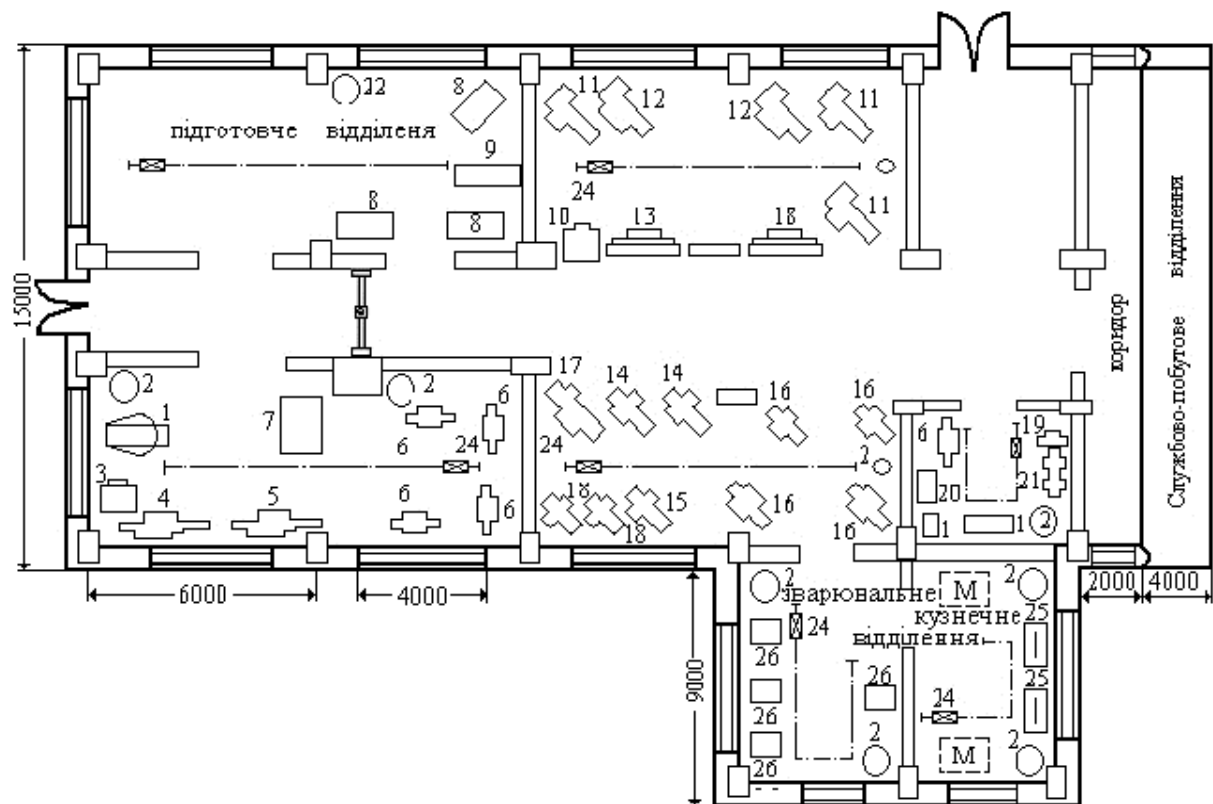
Схематичний план ремонтно-механічного цеху.
